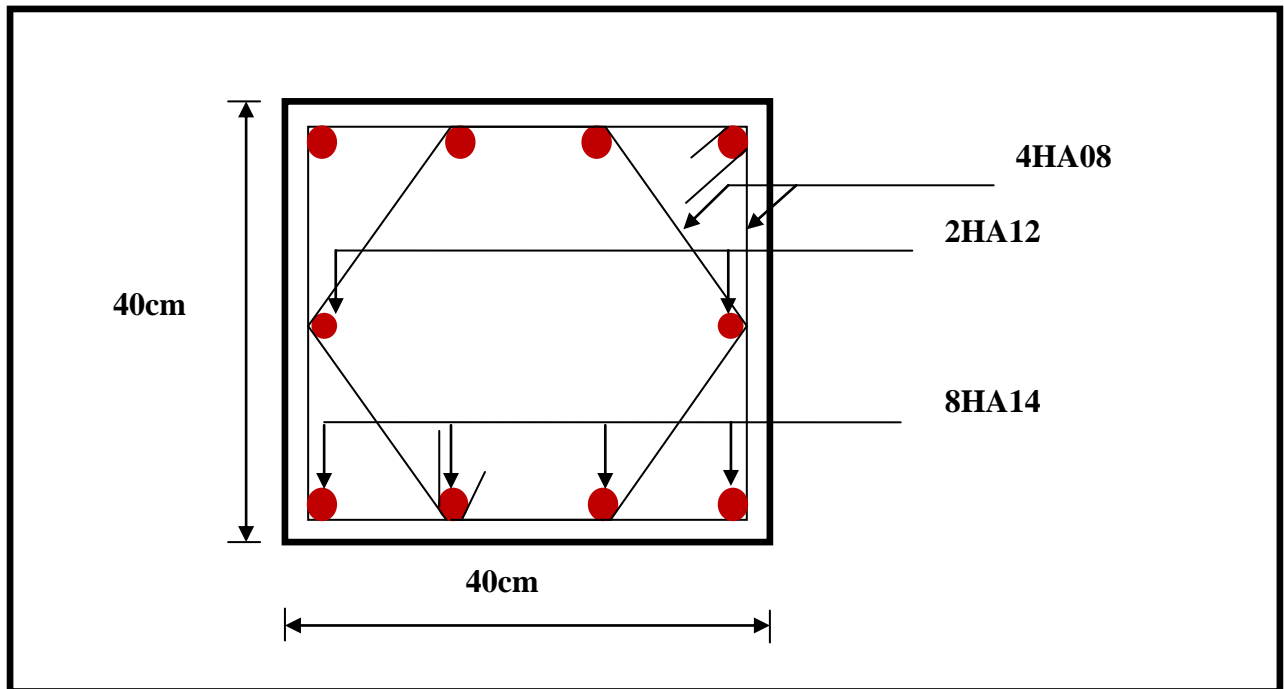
Ferrailage Poteau 40 × 40
